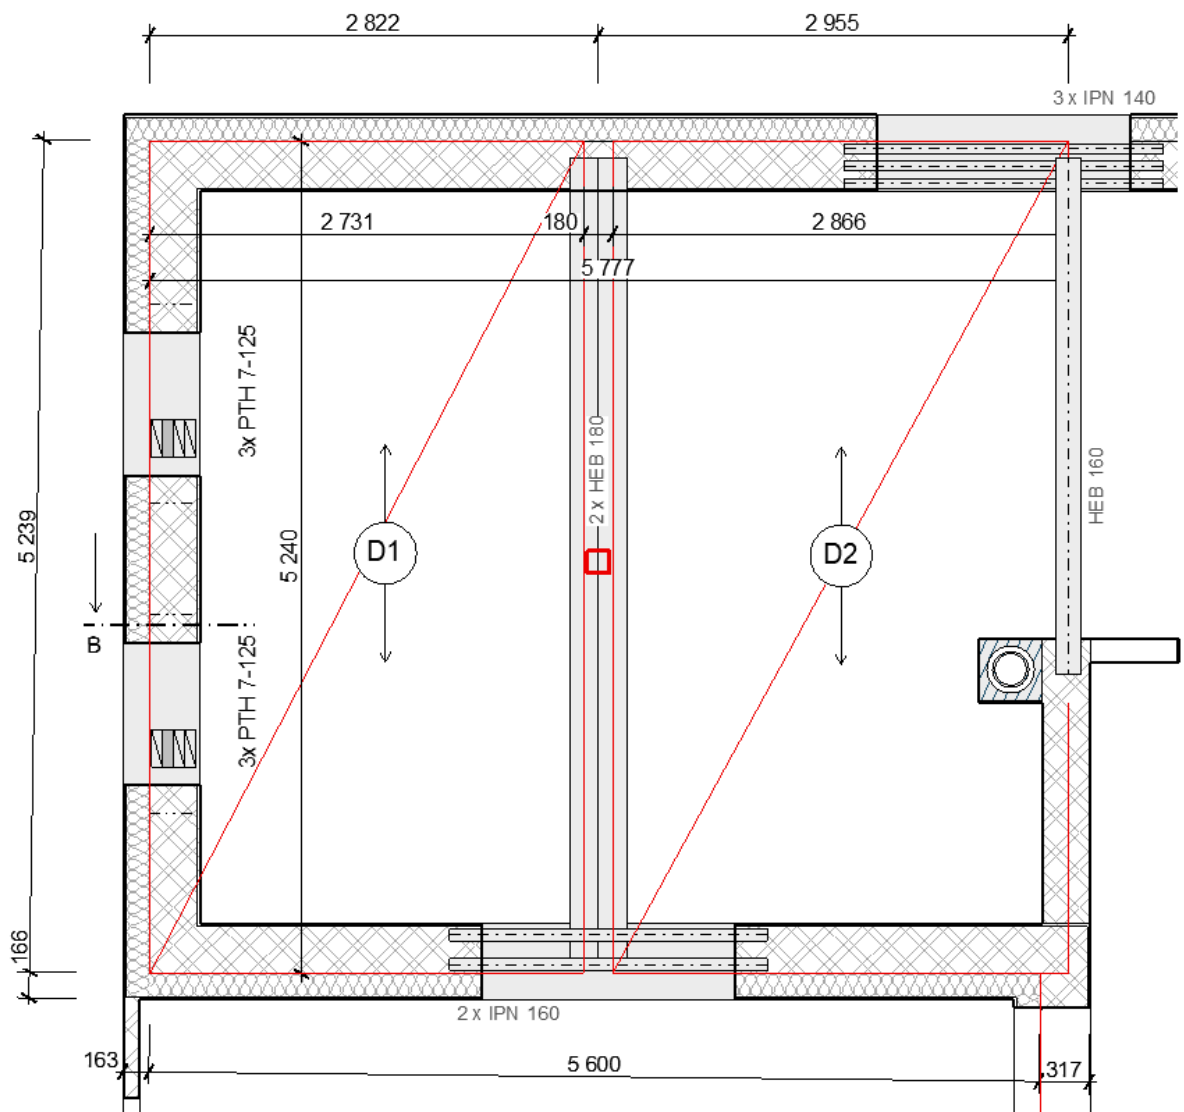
detail řezu stropní konstrukce skutečné provedení se změnami
